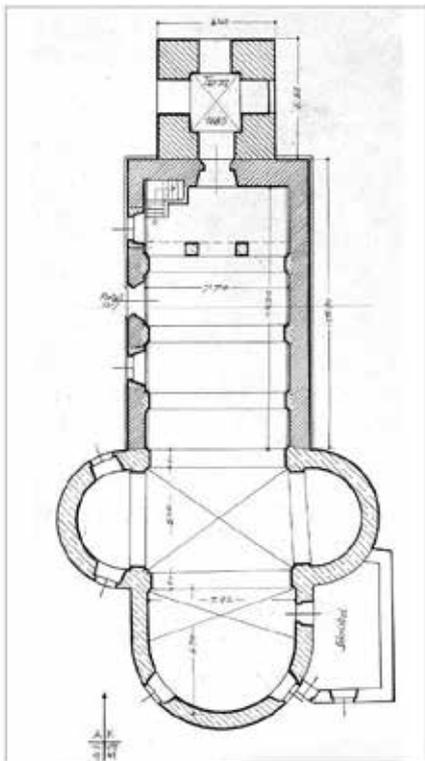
Anger – 14-Nothelfer-Kirche - Grundriss
